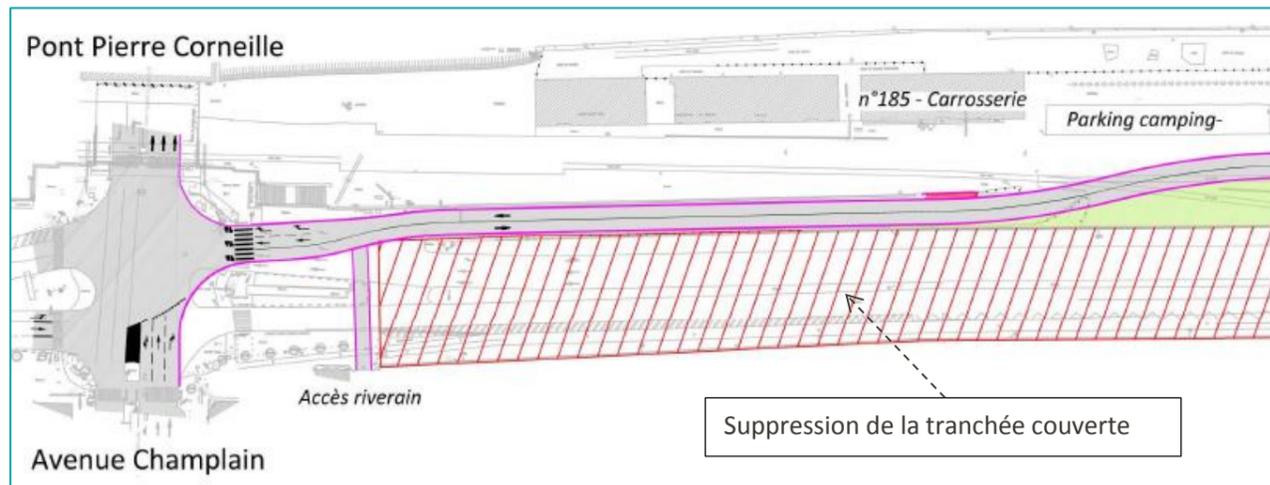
Plan du raccordement de la nouvelle voirie au droit du pont Corneille
